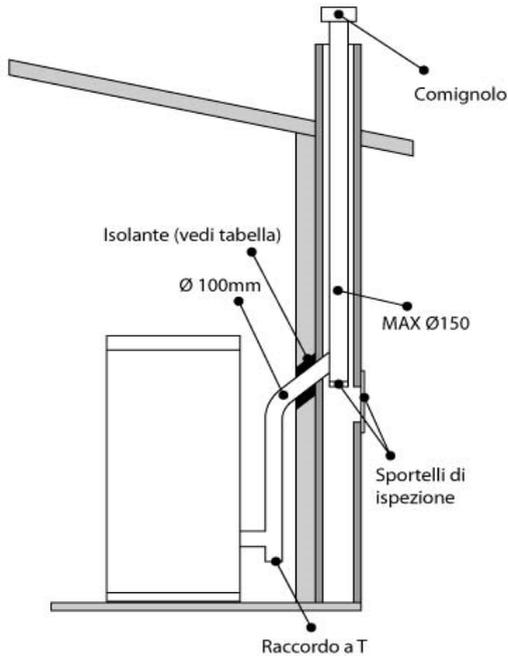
Évacuation par conduit de fumées traditionnel
